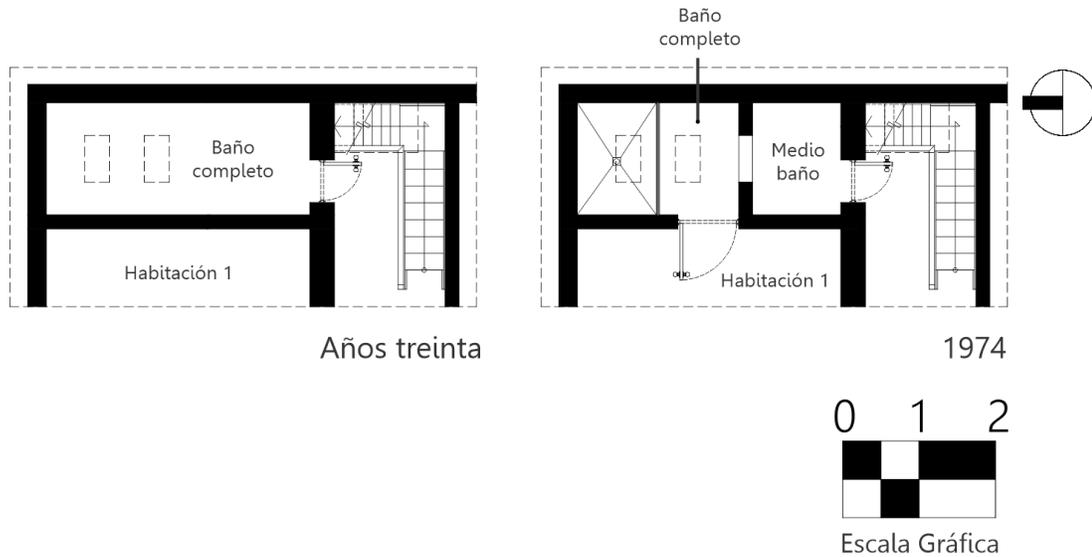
Sección de plantas arquitectónicas donde se muestra la división del baño en el año de 1974. Elaborado por KNV.
